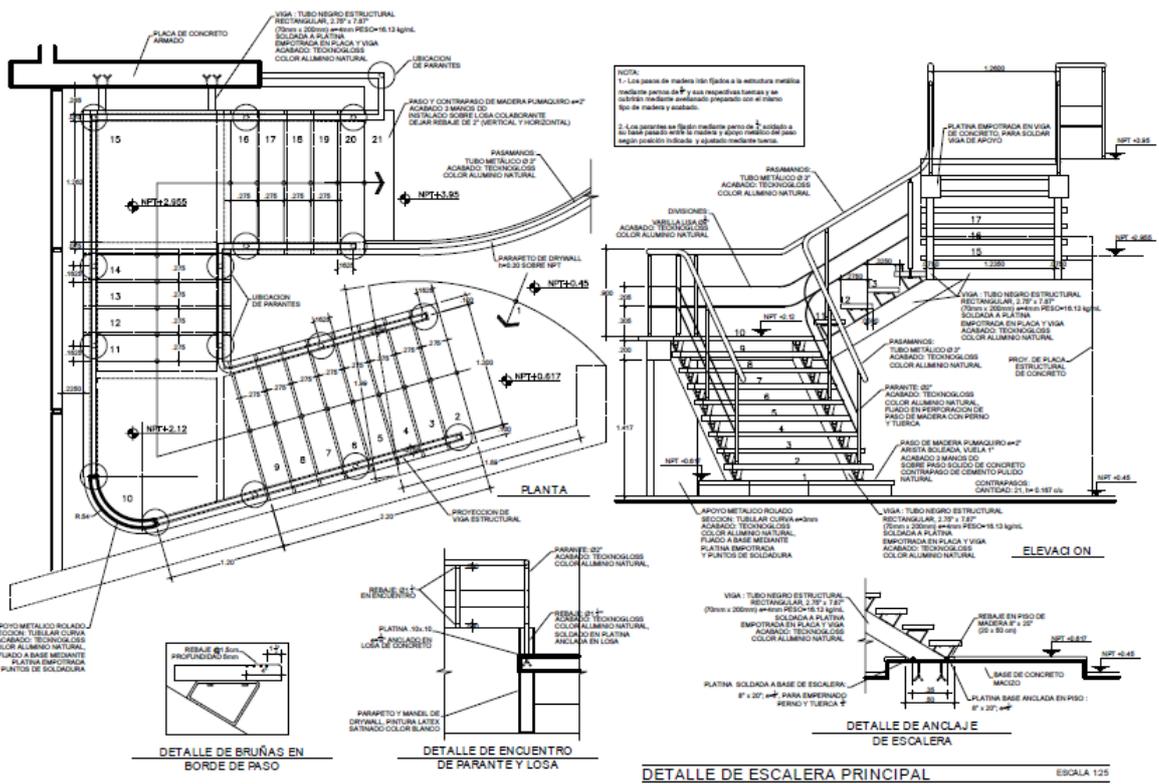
Detalle de escalera metálica con pasos de madera
